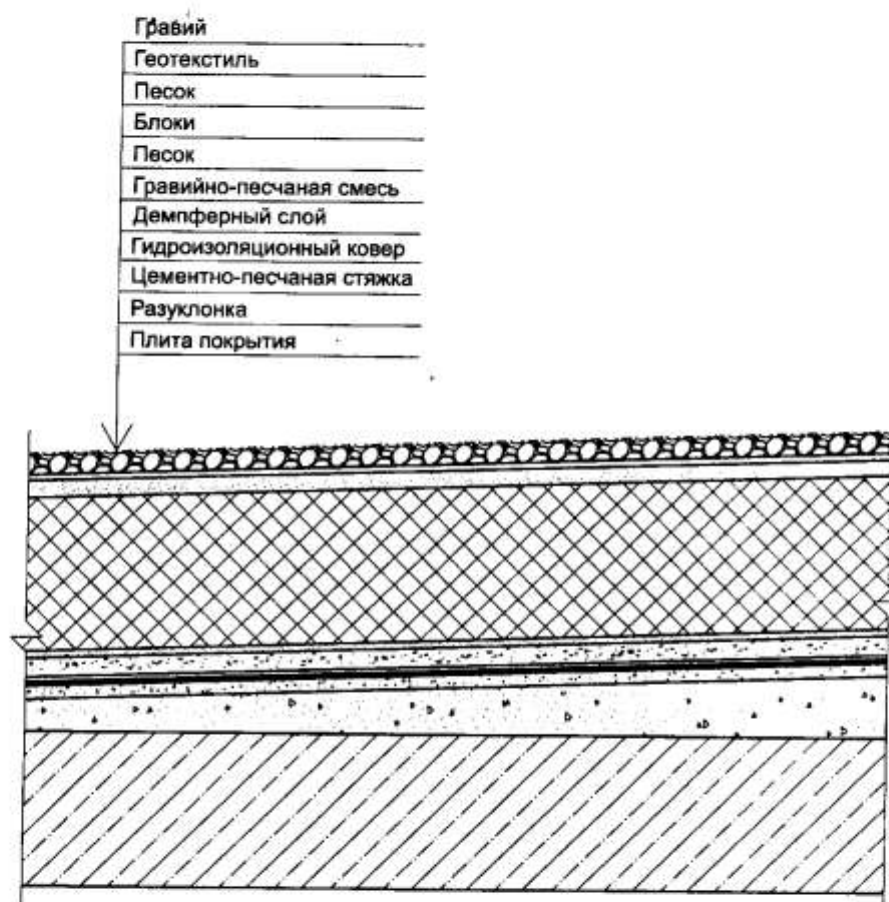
Тепловая изоляция инверсионной кровли с пригрузом из гравия
